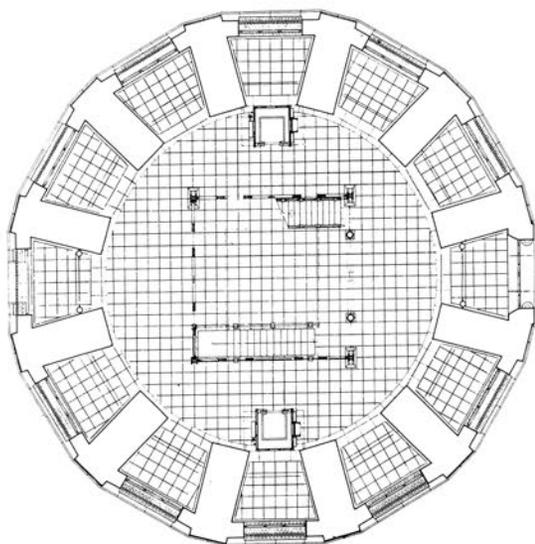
Estado actual de la planta baja del depósito elevado.
